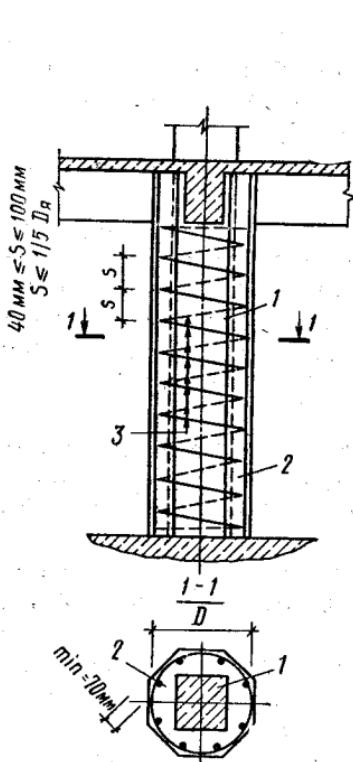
Усиление колонны обоймой со спиральной арматурой:
